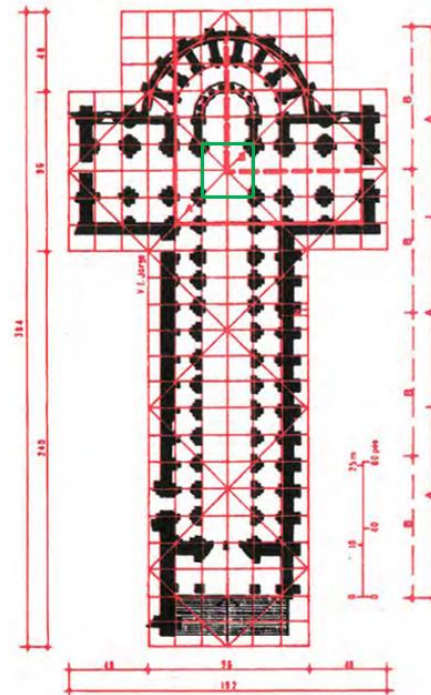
Planta medieval da igreja da Abadia de Alcobaça (reconstituição) no traçado modular.
